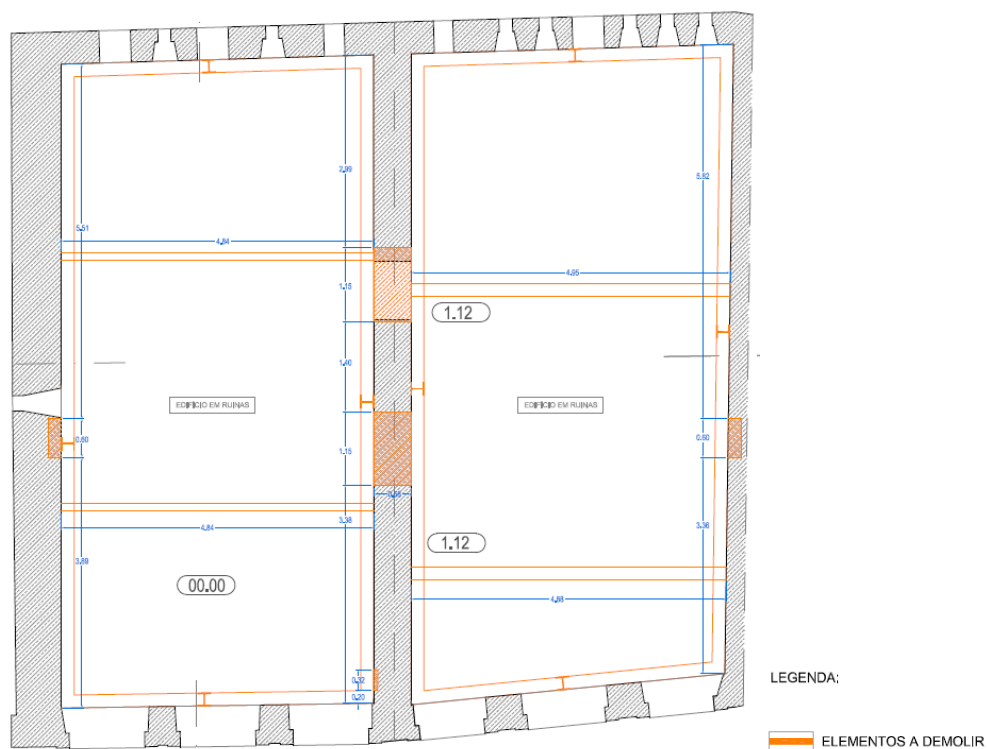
Planta do rés-do-chão com elementos a demolir - Fonte: Desenhos de Arquitetura da Operação E2 - Projeto 9
